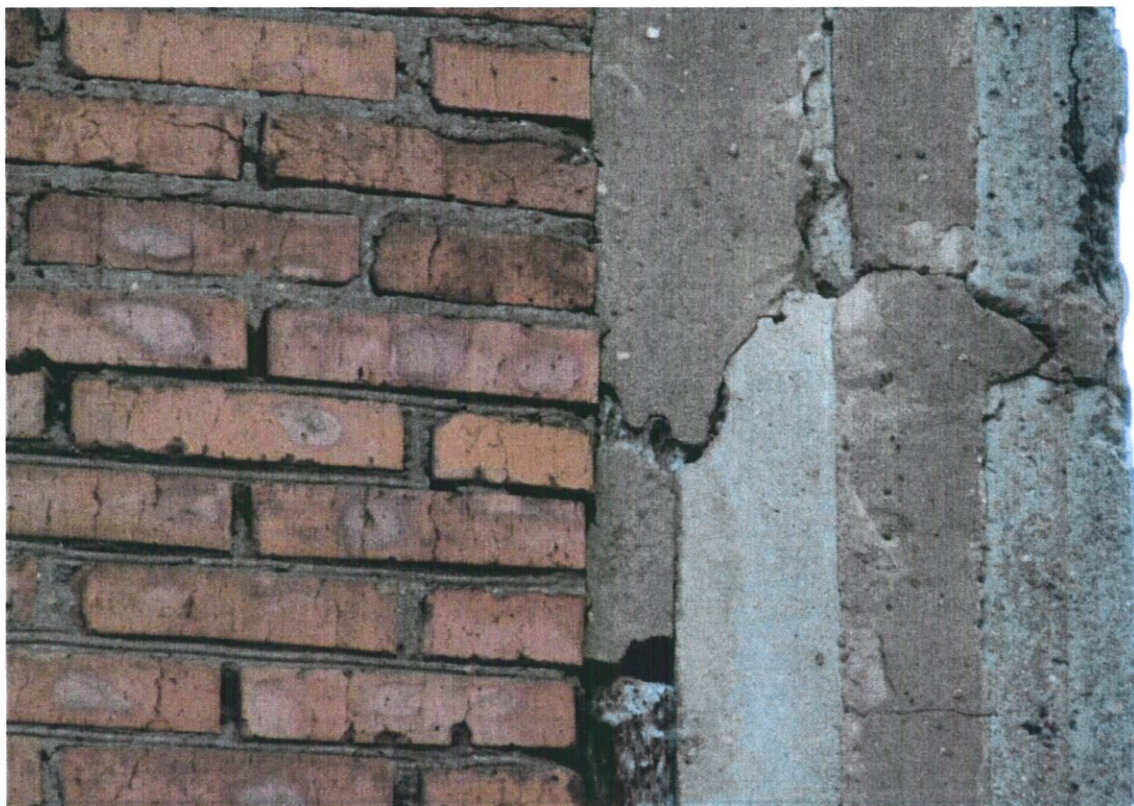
В торце здания цементная заделка примыканий каменной кладки торцевой стены к железобетонным панелям потрескалась и осыпается.
